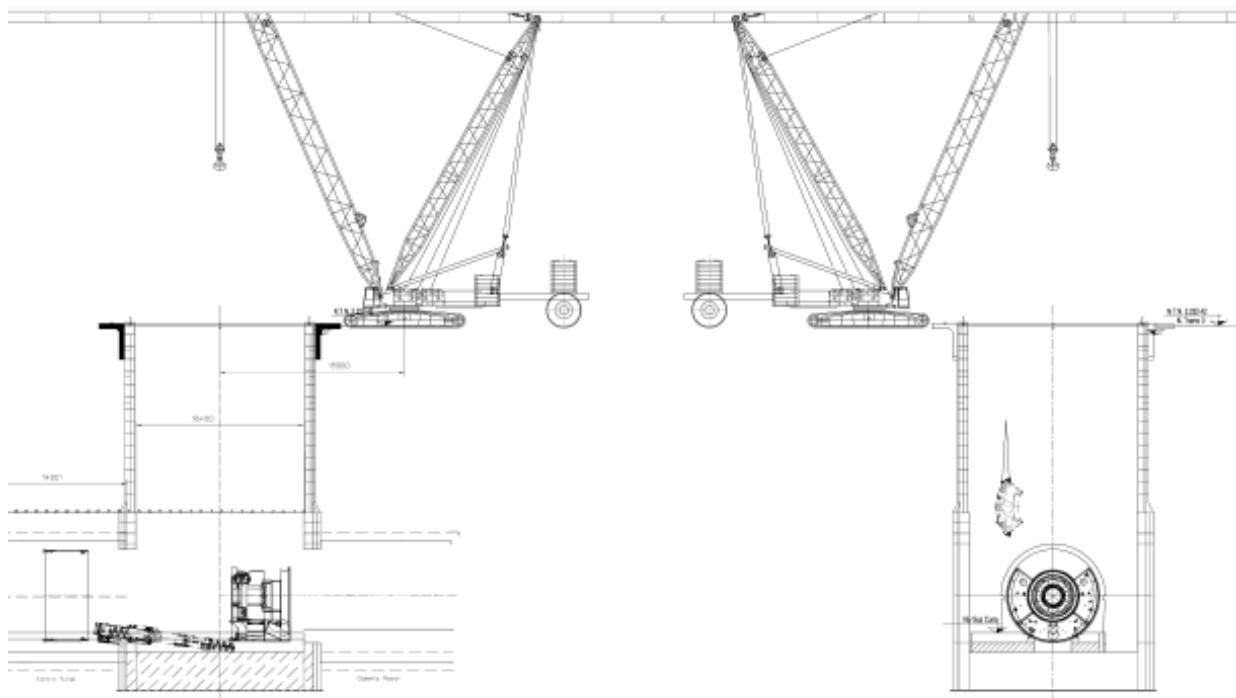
Se baja y se instala el lateral izquierdo de la cabeza de corte.⁹⁹
